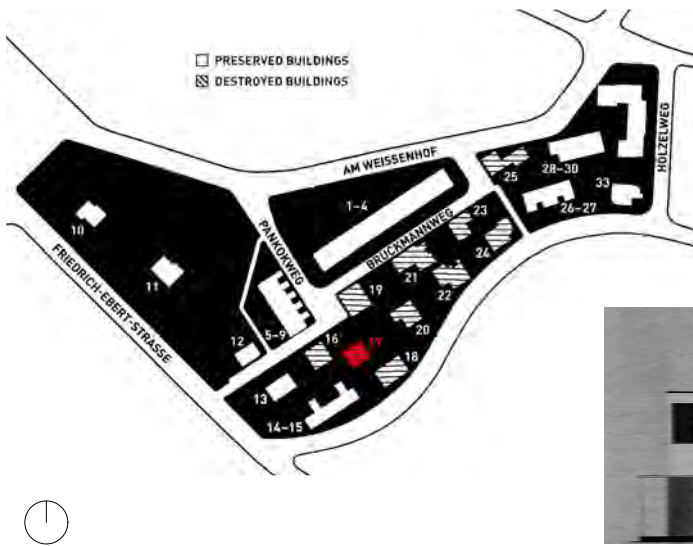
Planta de Implantação da Casa de Walter Gropius
